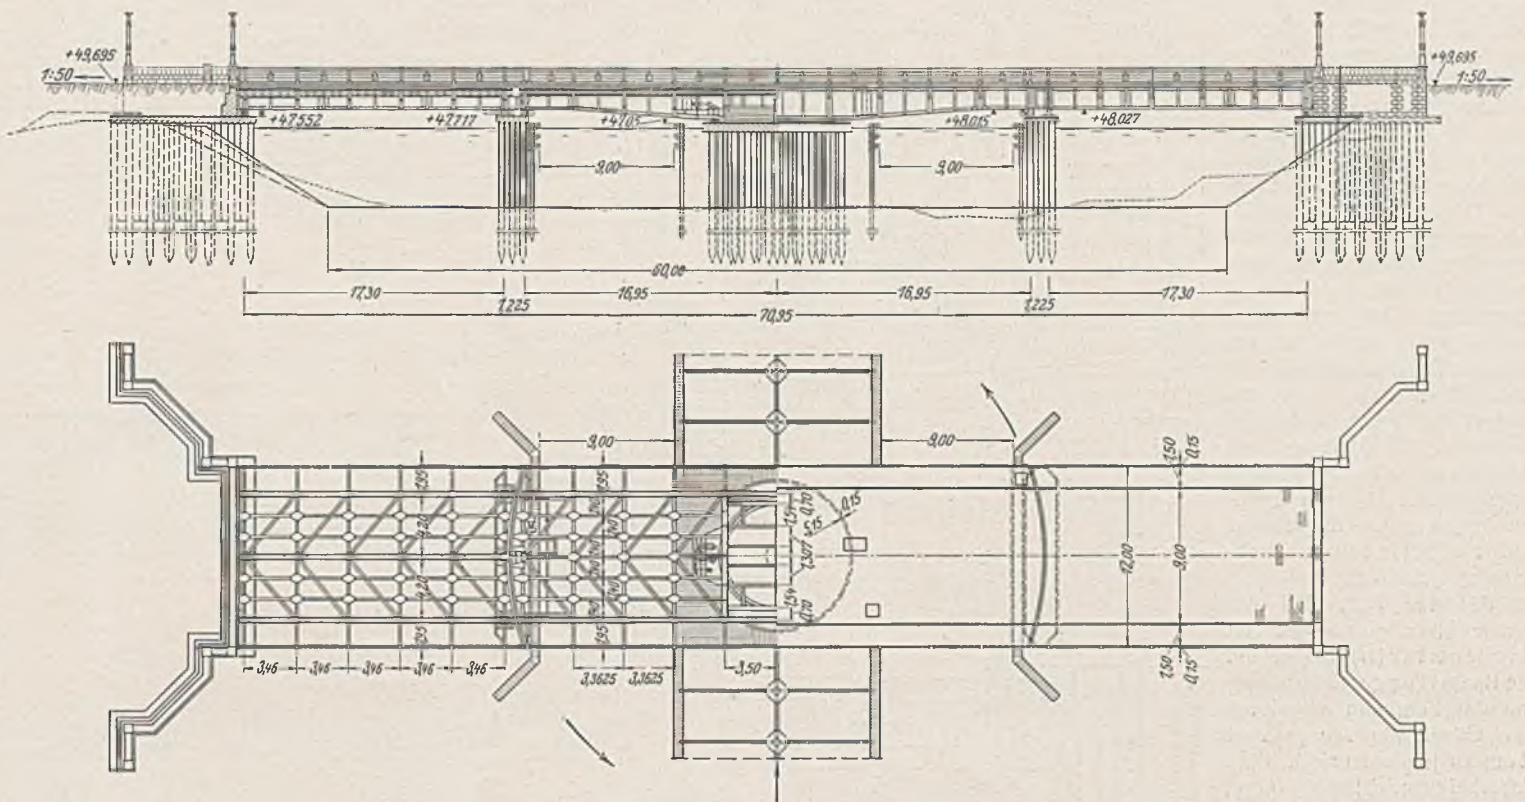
Ansicht und Grundriß der Brückenanlage.
